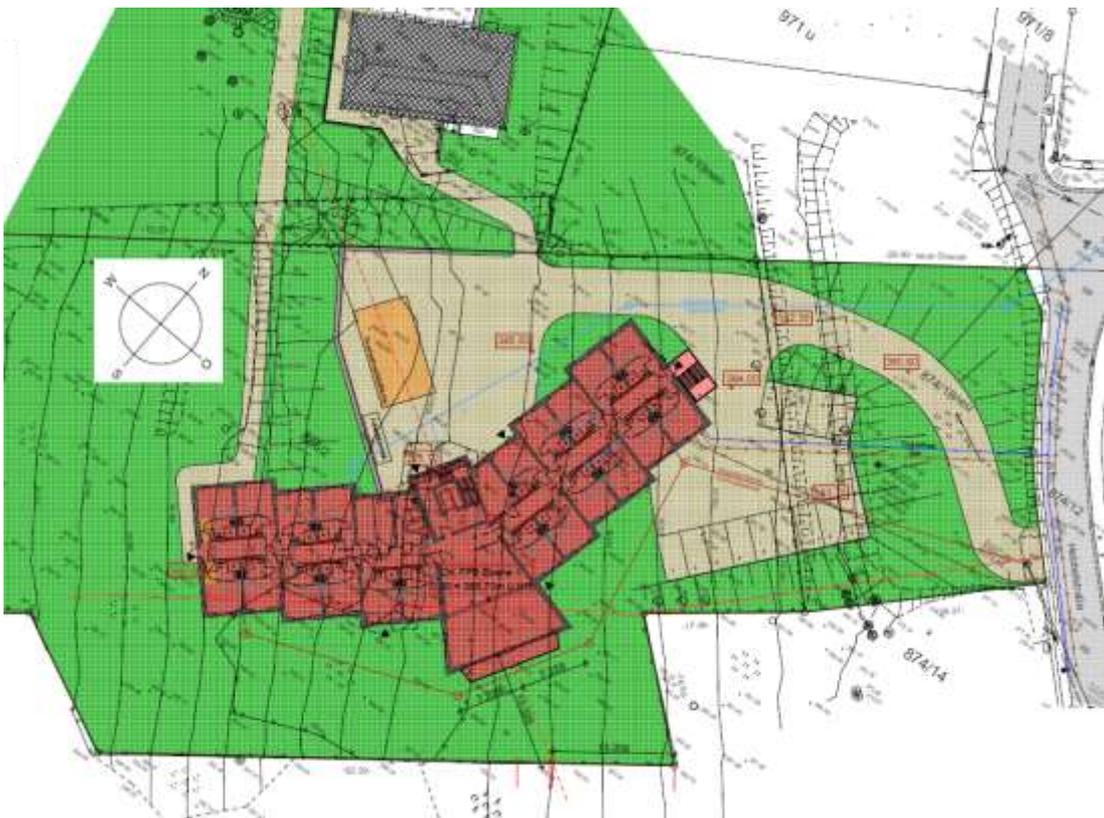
Lageplan, Auszug aus dem Bauantrag
